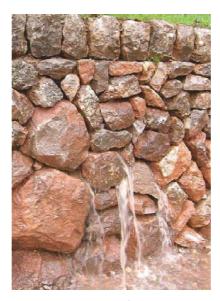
Ecoulement des eaux pluviales à travers un mur en pierres sèches
